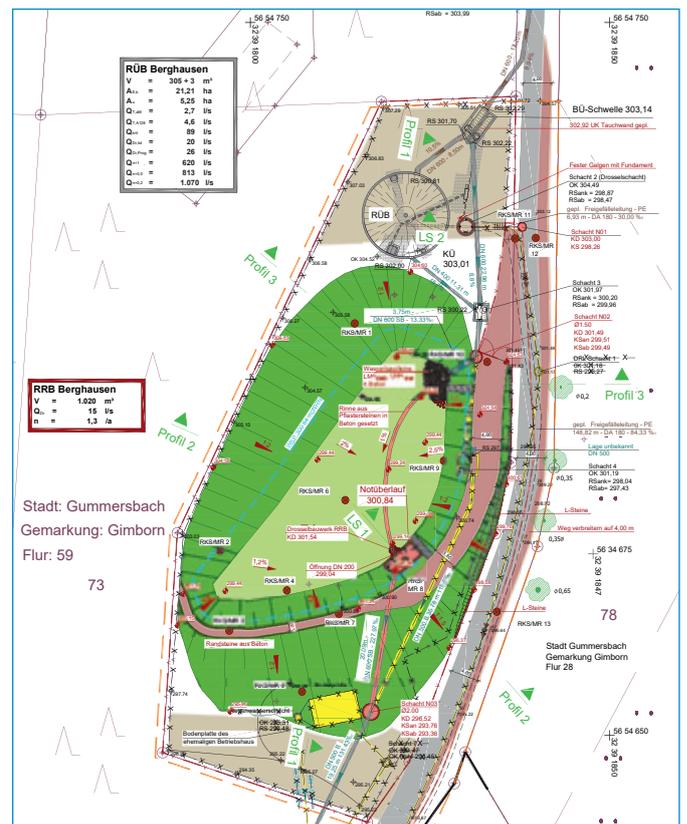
Lageplan Regenrückhaltebecken Berghausen
